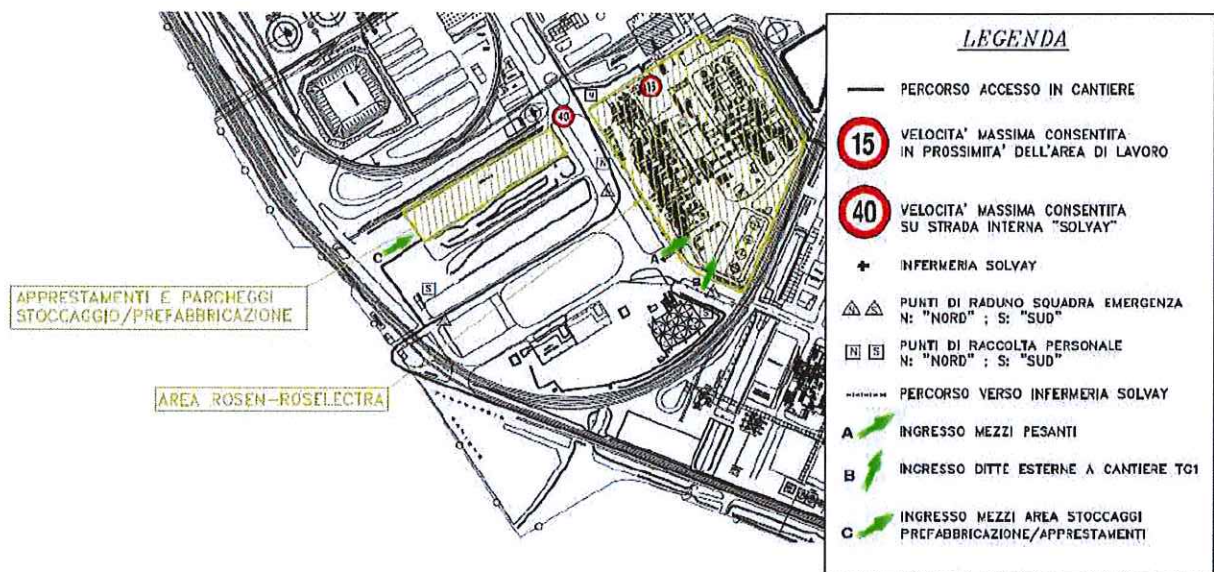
Planimetria generale con riferimenti principali e percorsi per accesso in cantiere (da PSC)
